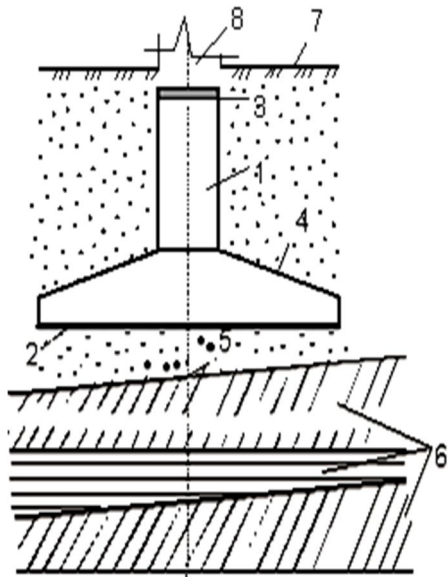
влаштування фундаменту неглибокого закладання:
